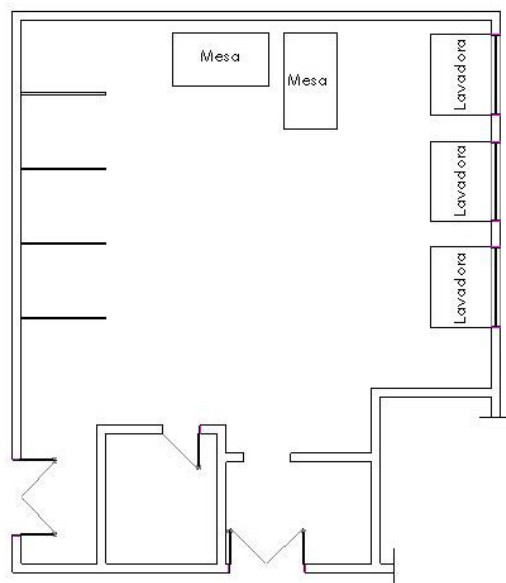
LAYOUT DA ÁREA SUJA DA LAVANDERIA (SEM ESCALA)
